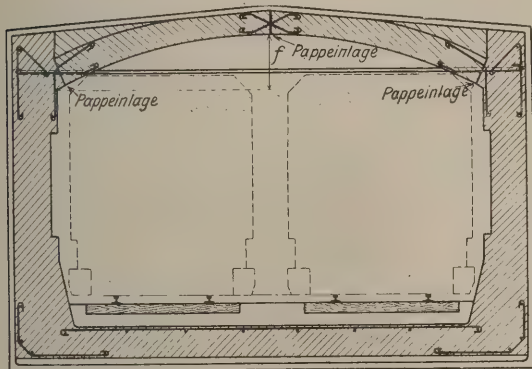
a. Querschnitt eines normalen Unterpflasterbahntunnels jetzt üblicher Bauart (mit vollständiger Bewehrung).
